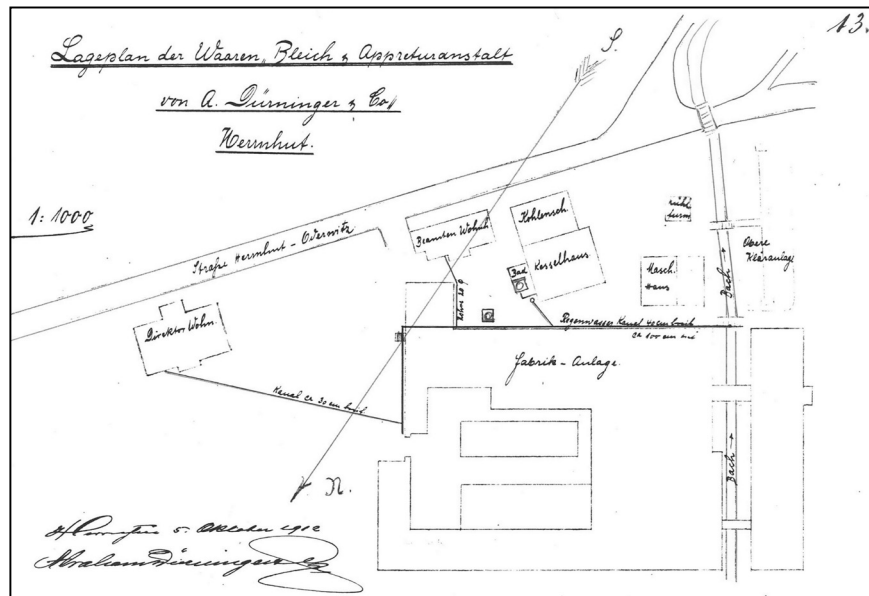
Lageplan ADC mit Abwasserrohrleitung 1 m tief. Zeichnung Nr. 13, 05.10.1912. Beim Kesselhaus ist „Bad“ eingetragen. (Quelle: UA ADC.669)
